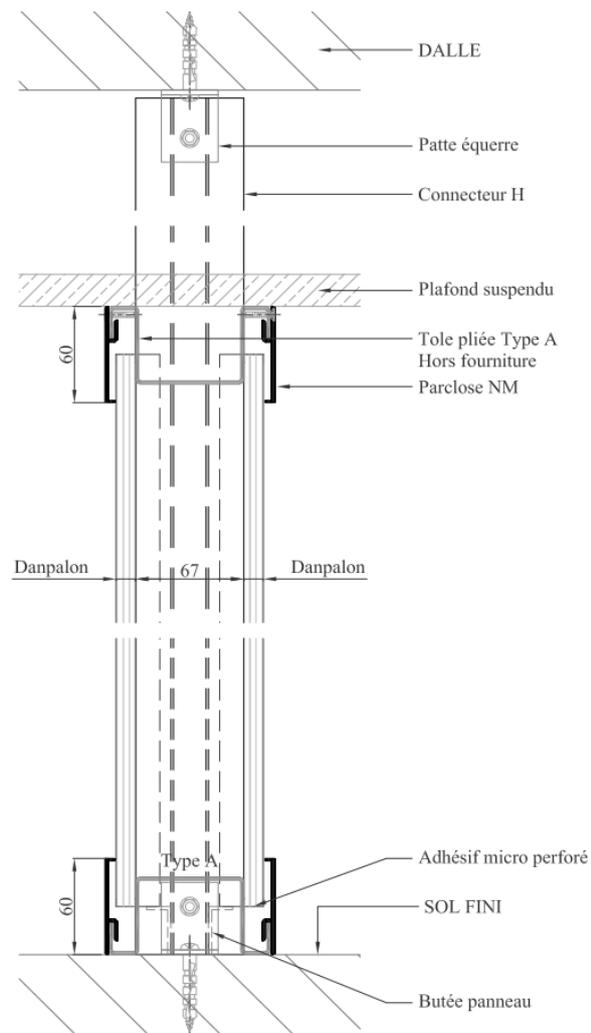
Coupe verticale – Système DANPALON® application cloison double paroi
